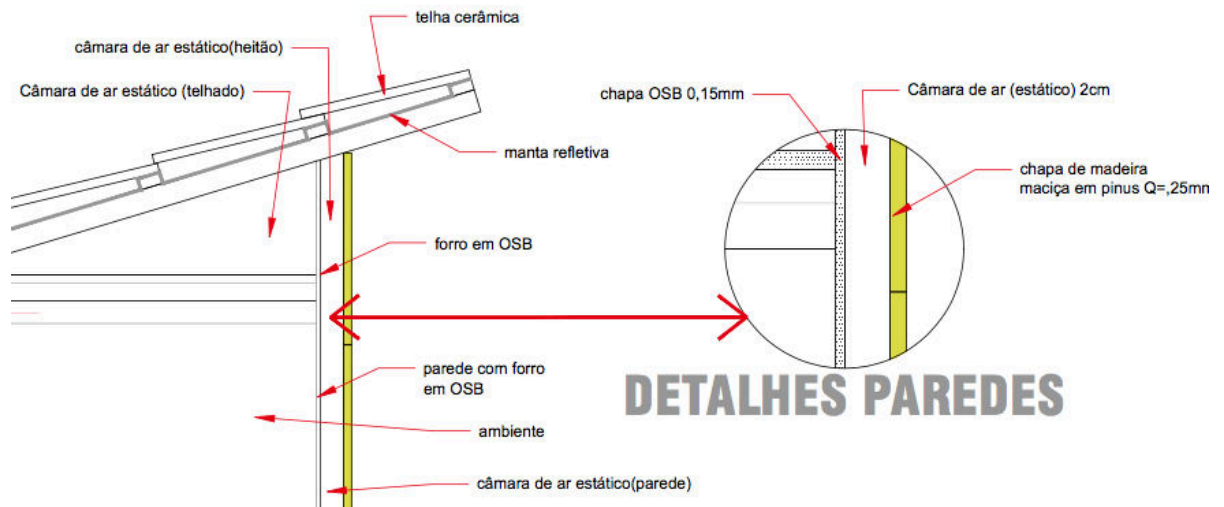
Detalhes construtivos câmaras de ar estático (telhado e paredes).
